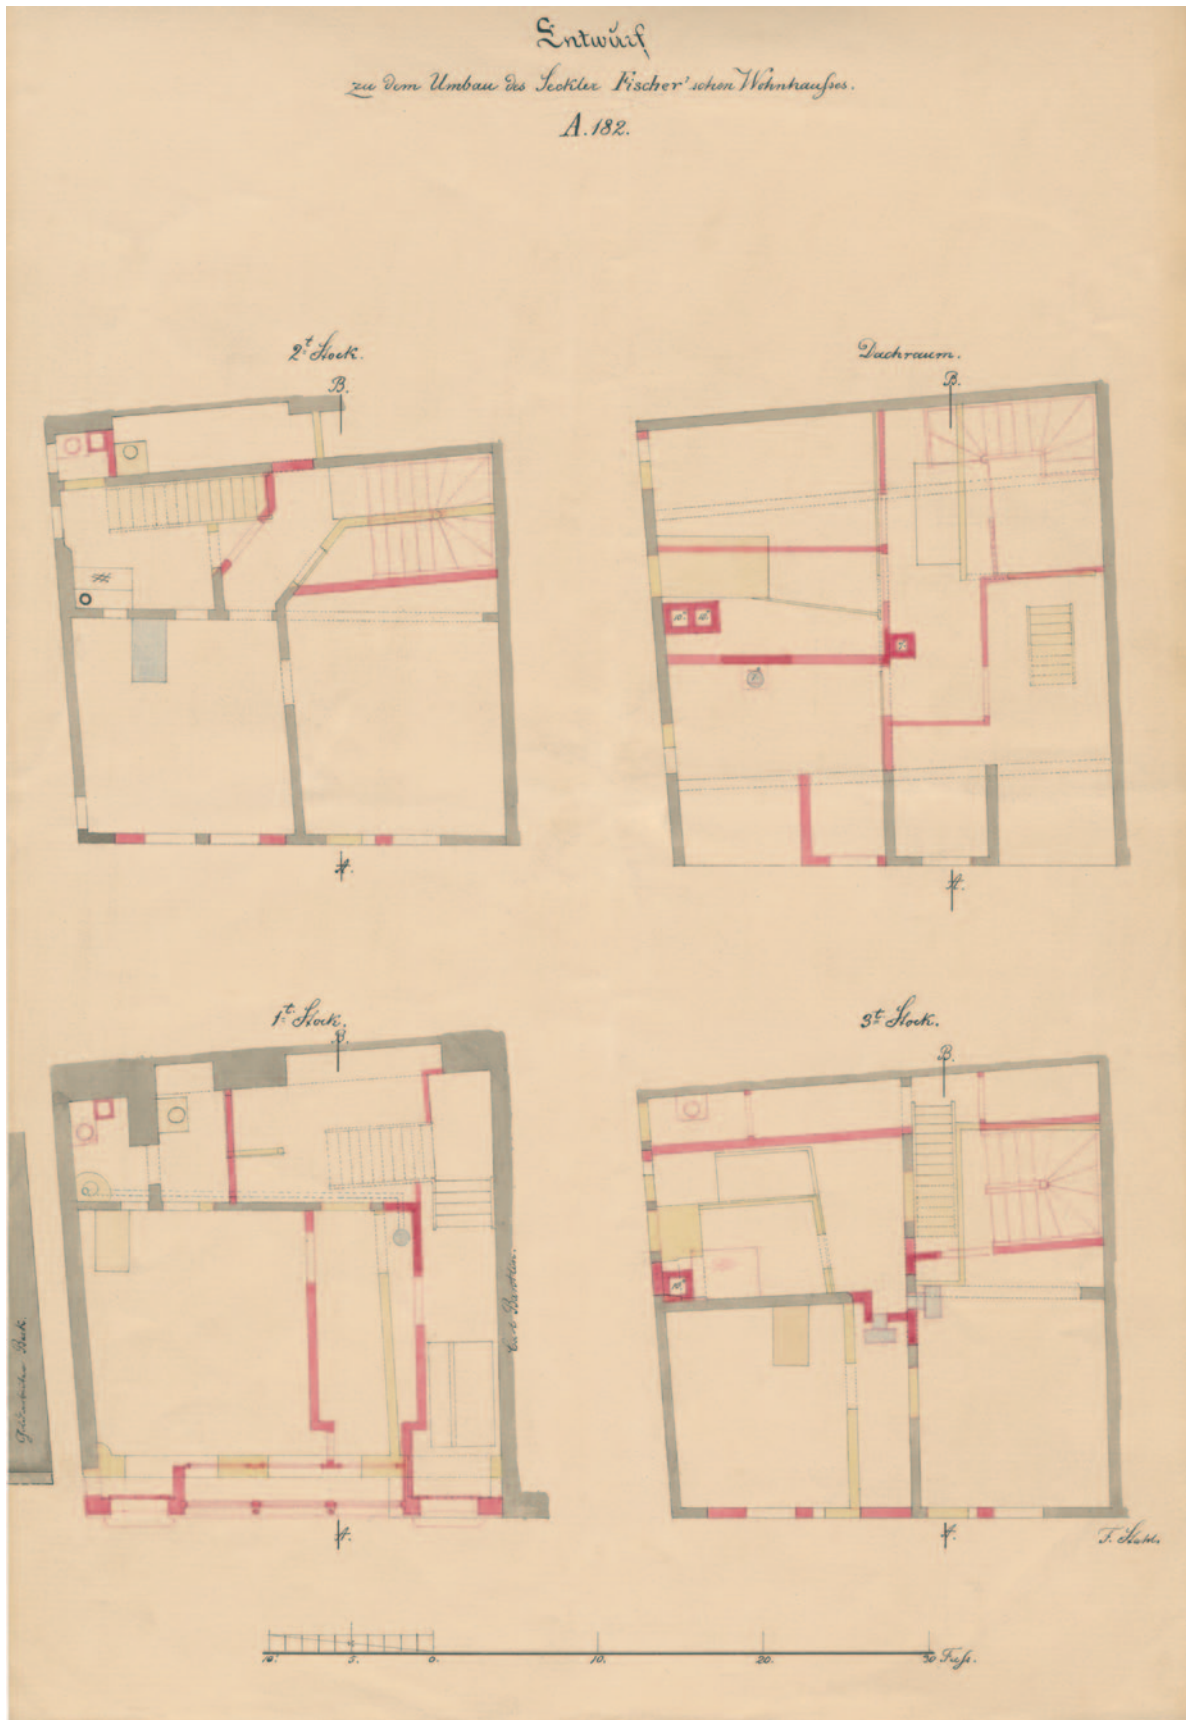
Gebäude Lange Straße 2 (A 182), Grundrisse, Baugesuch 1859.
